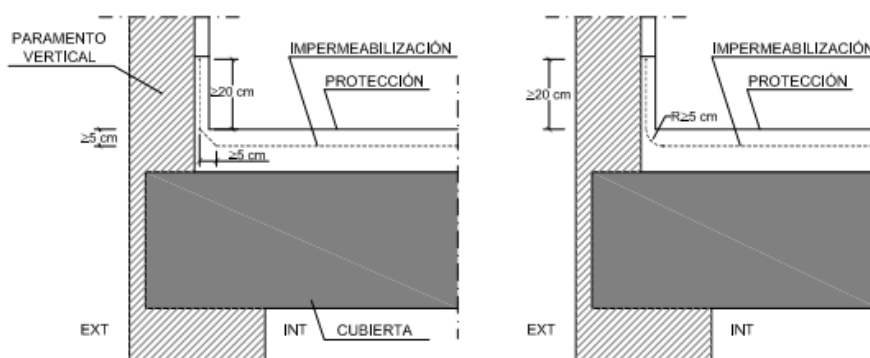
Encuentro de la cubierta con un paramento vertical
